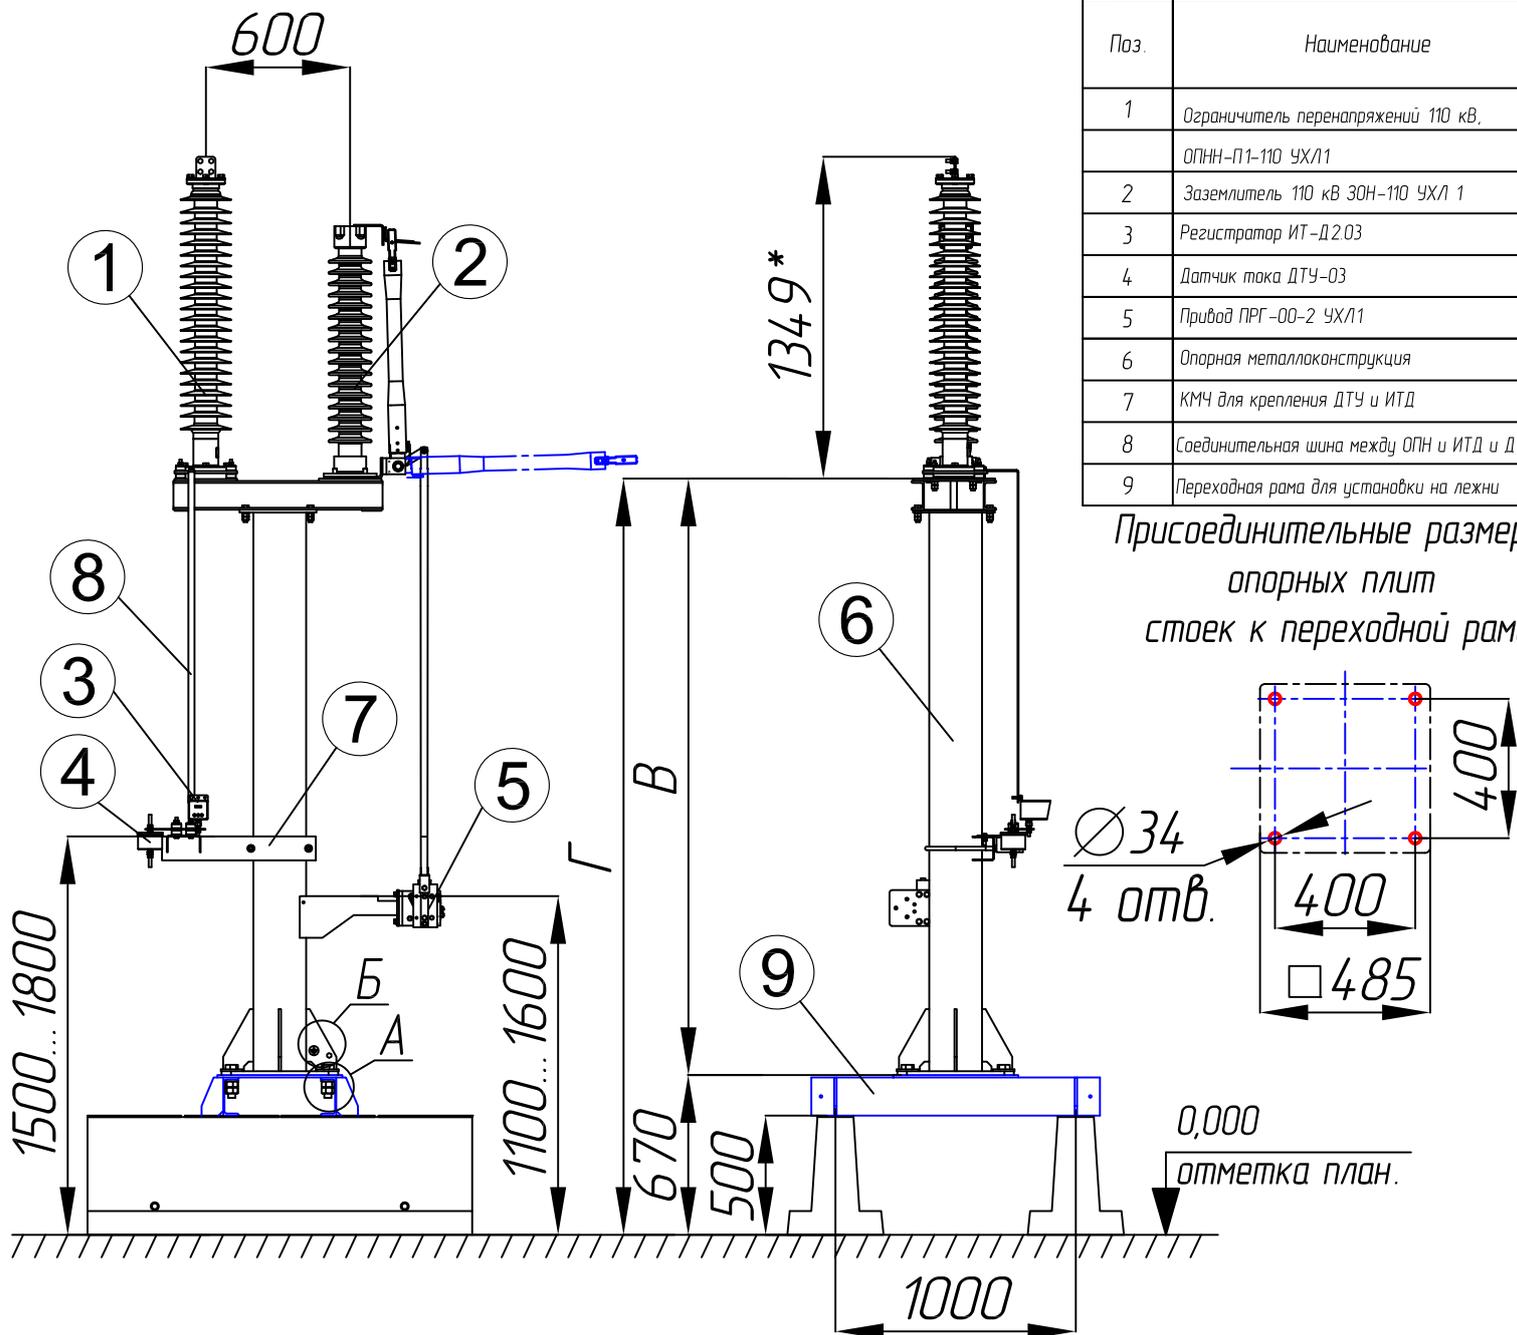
Установка блока ЗОН и ОПН на монолитный фундамент
